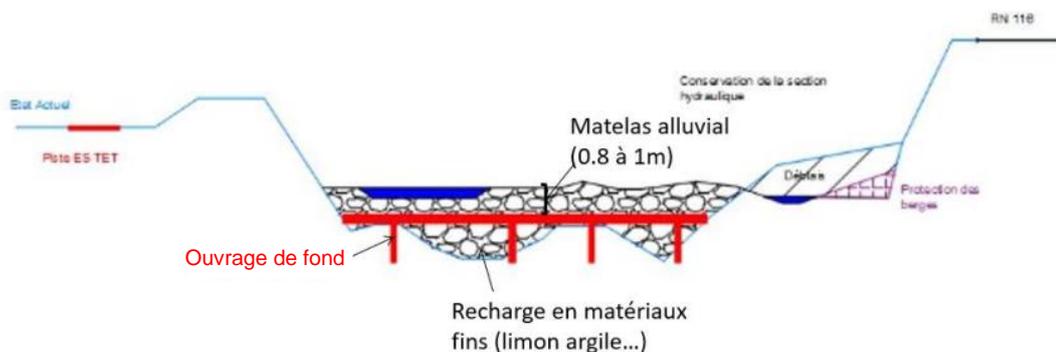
Exemple de profil en travers avec ouvrage de fond
